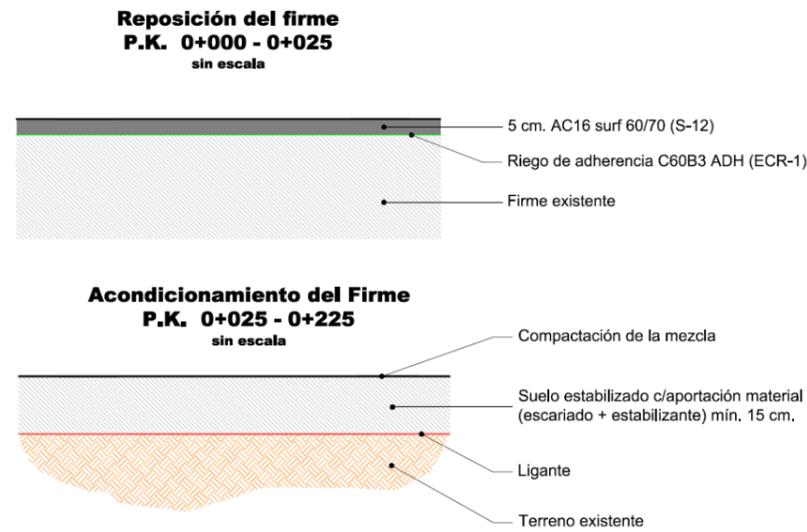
Plano 2.4.3. Secciones tipo y detalles
